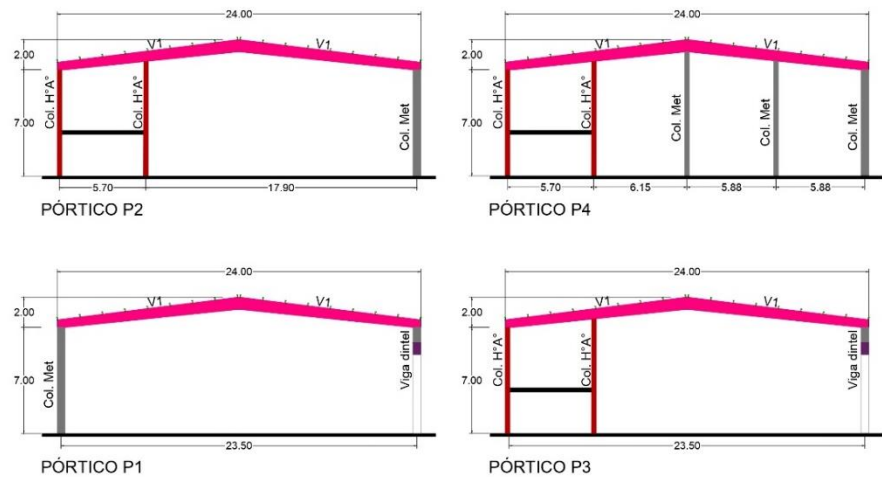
Pórticos Tipo. Fuente: Elaboración propia.
